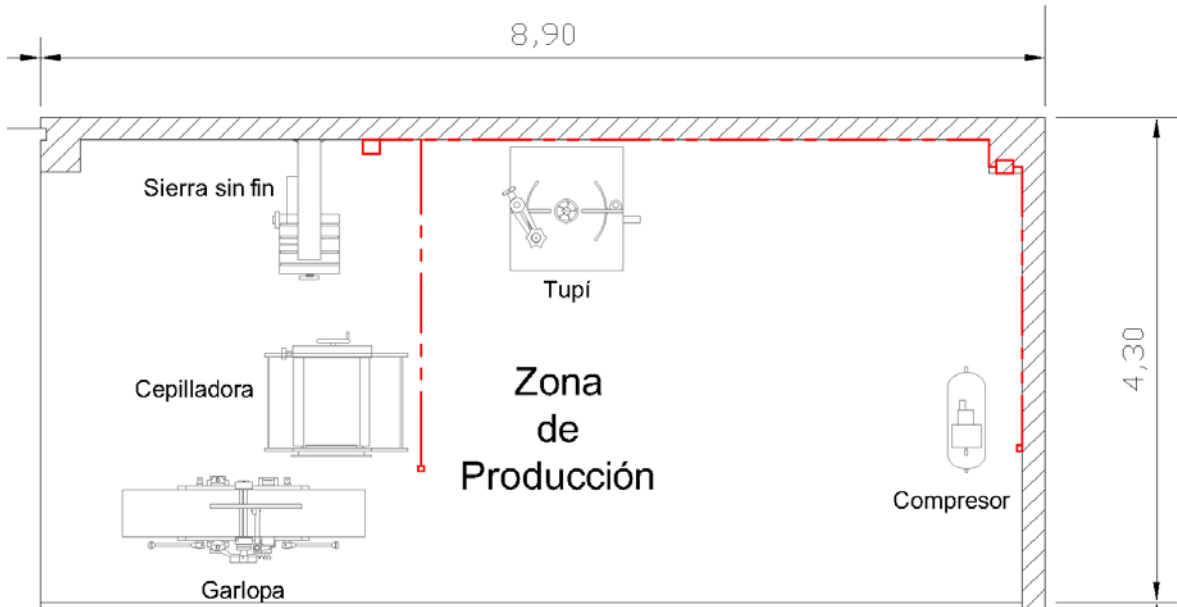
Vista de planta del área de producción con la instalación eléctrica señalada (elaboración propia).
